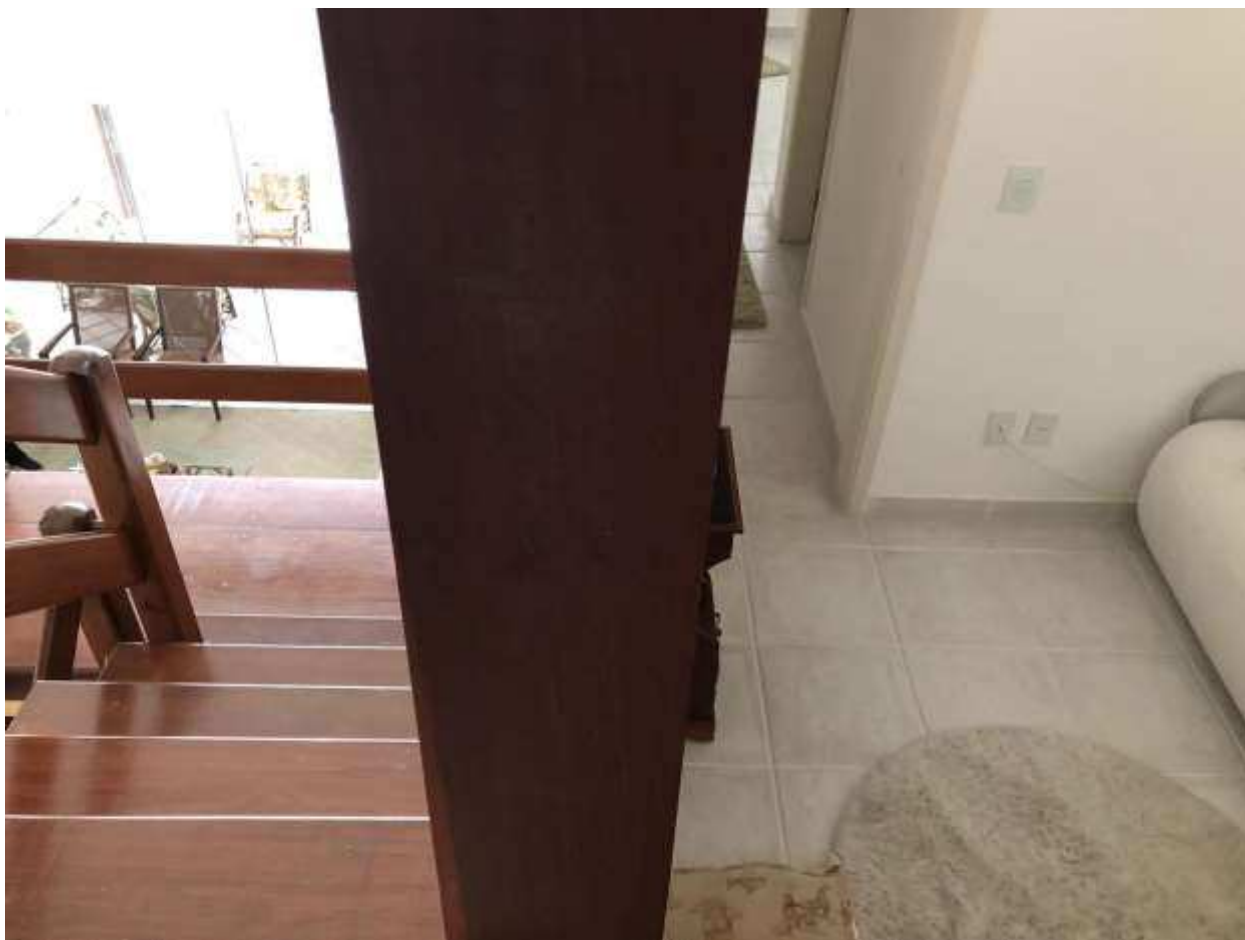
VISTA DA DIVISA DA ESCADA E DA SALA ÍNTIMA.
